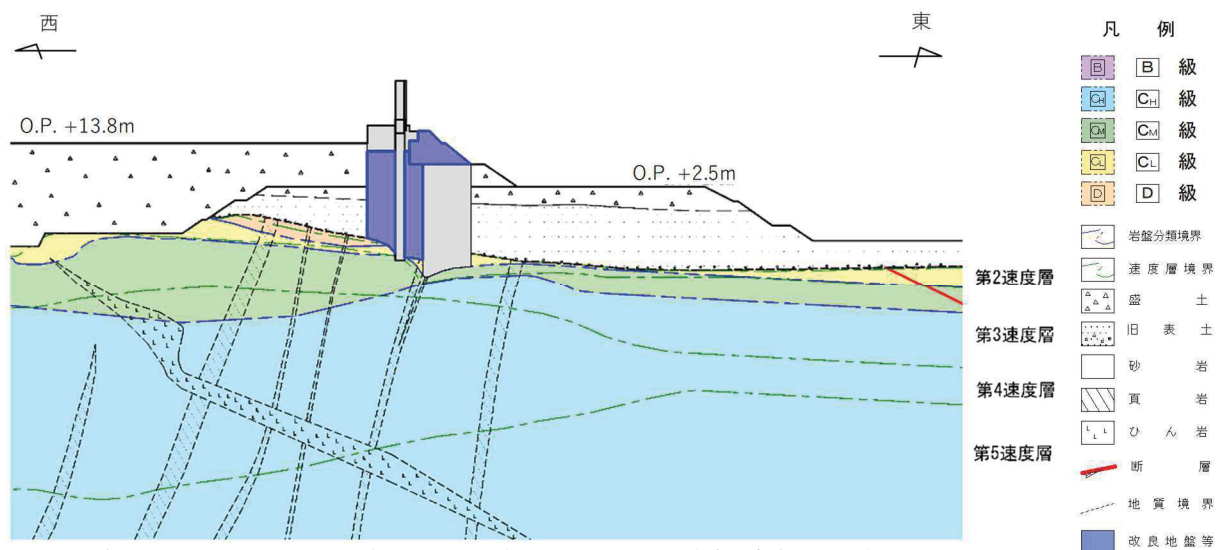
取水口の地質断面図 (㉕-㉕断面)
